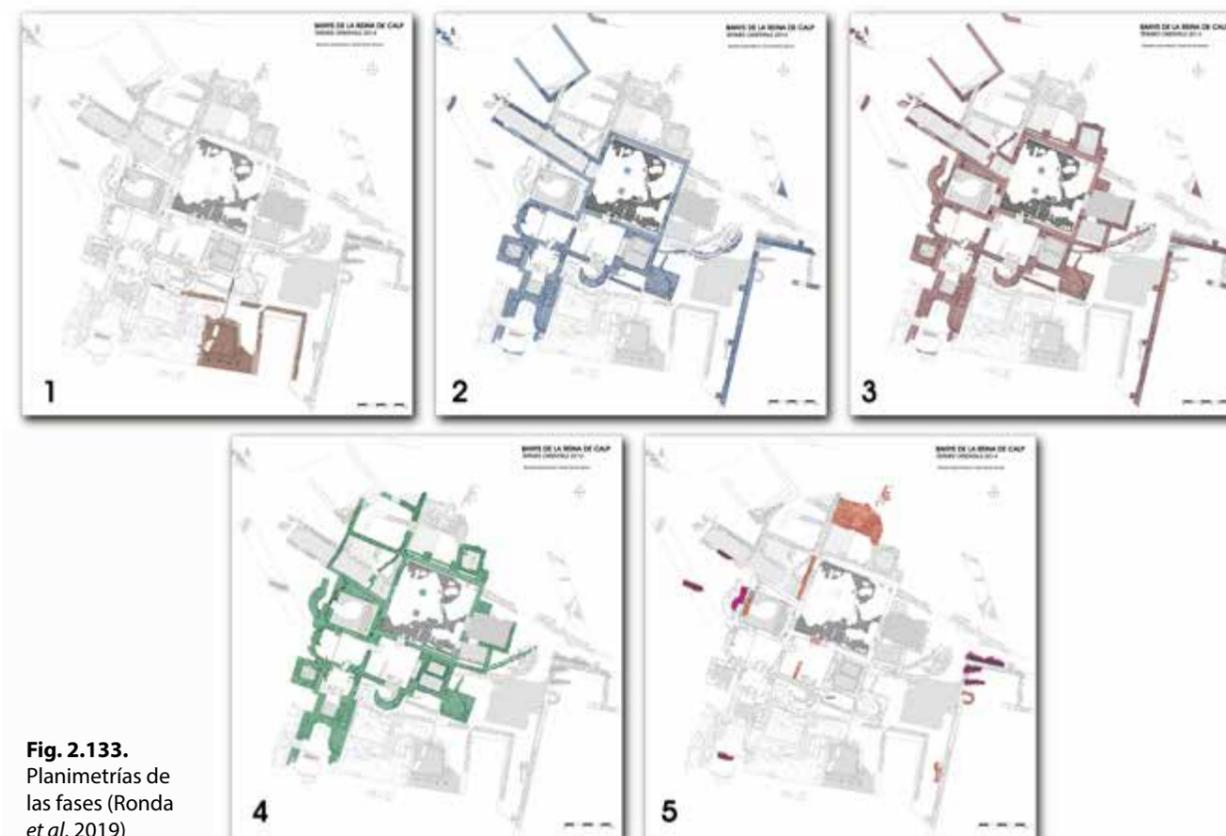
Planimetrías de las fases (Ronda et al. 2019)
